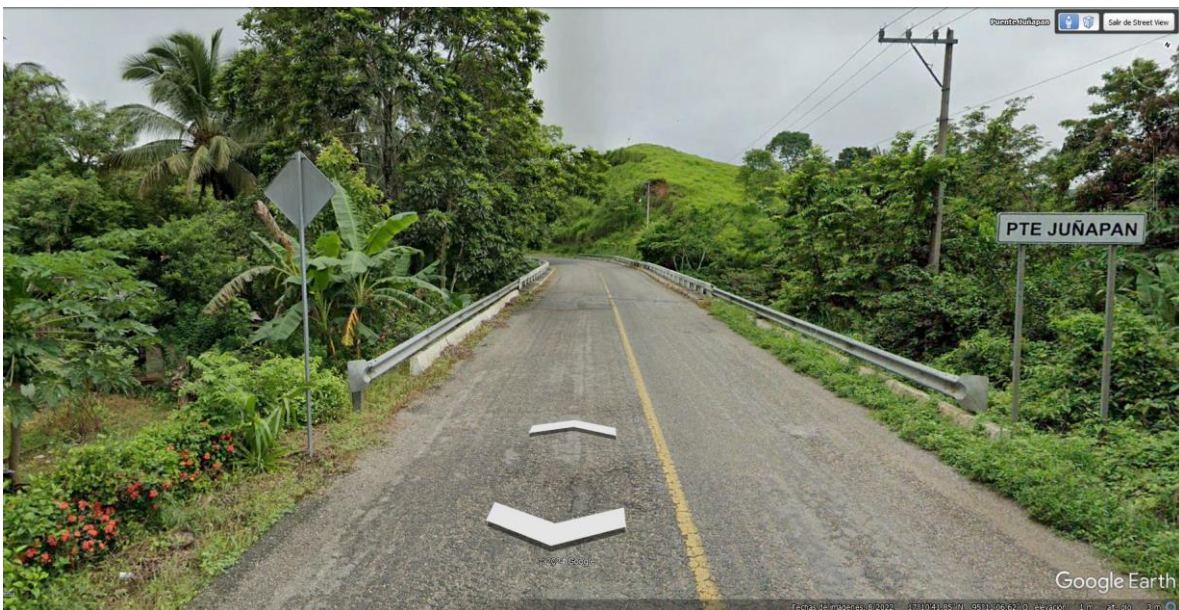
Puente vehicular Juñapan (Earth, Puente Juñapan Street view, 2022)
